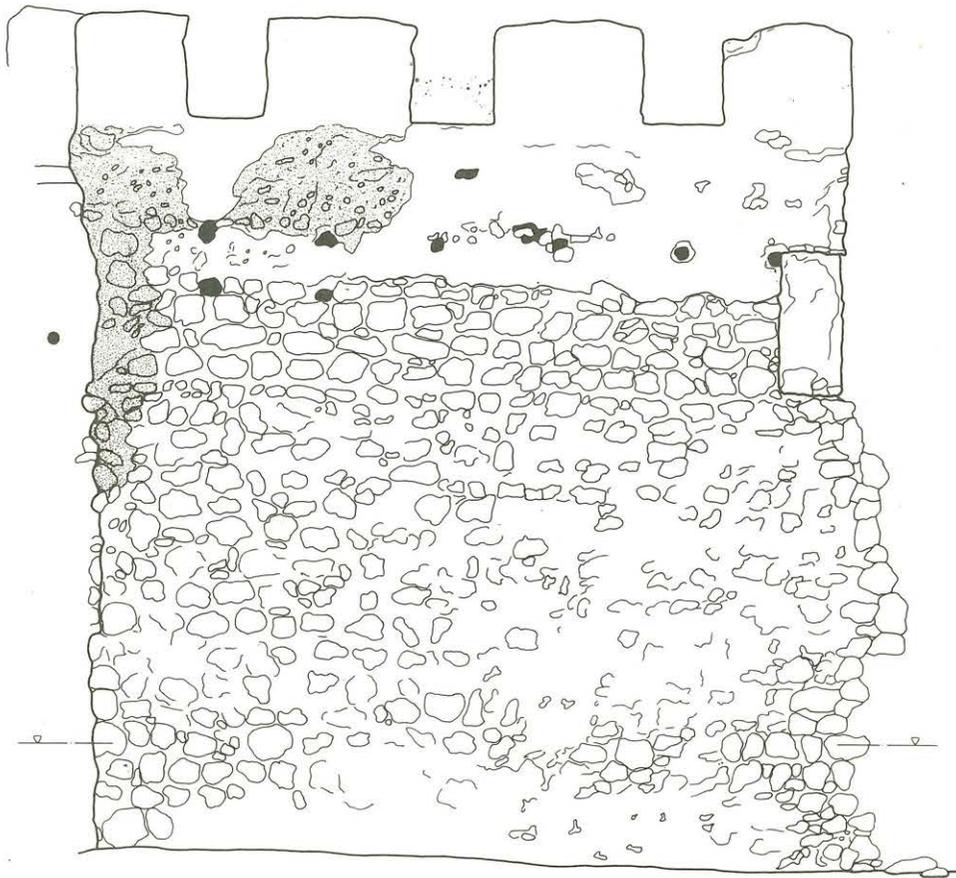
Alzado norte de la Torre B. Ibidem autor.
